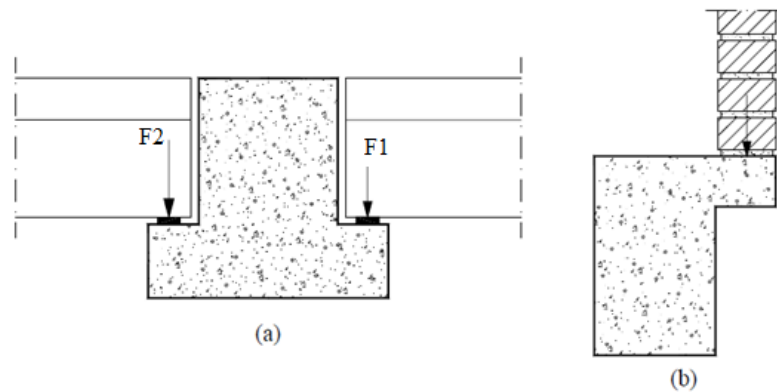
Vigas de suporte com carregamento excêntrico [7]
